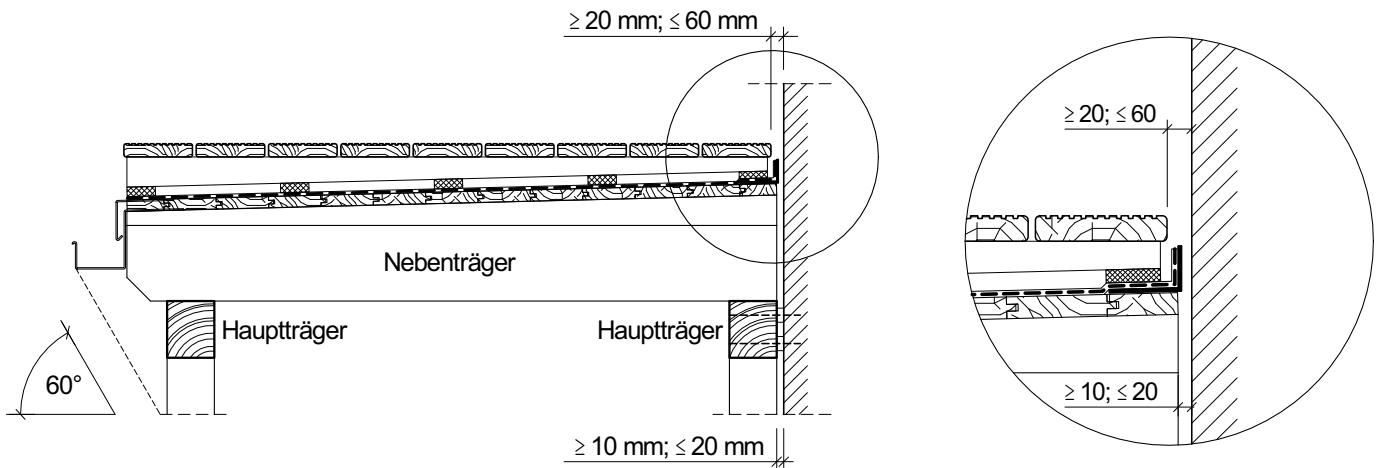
Geschlossener Balkon ohne Wandabdichtung
